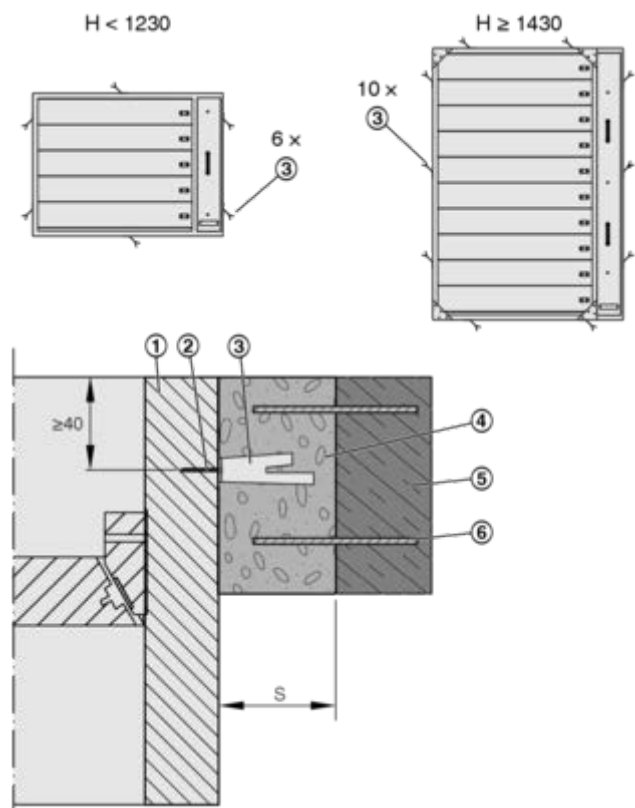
Installazione a base di malta EK-JZ con linguetta di fissaggio
